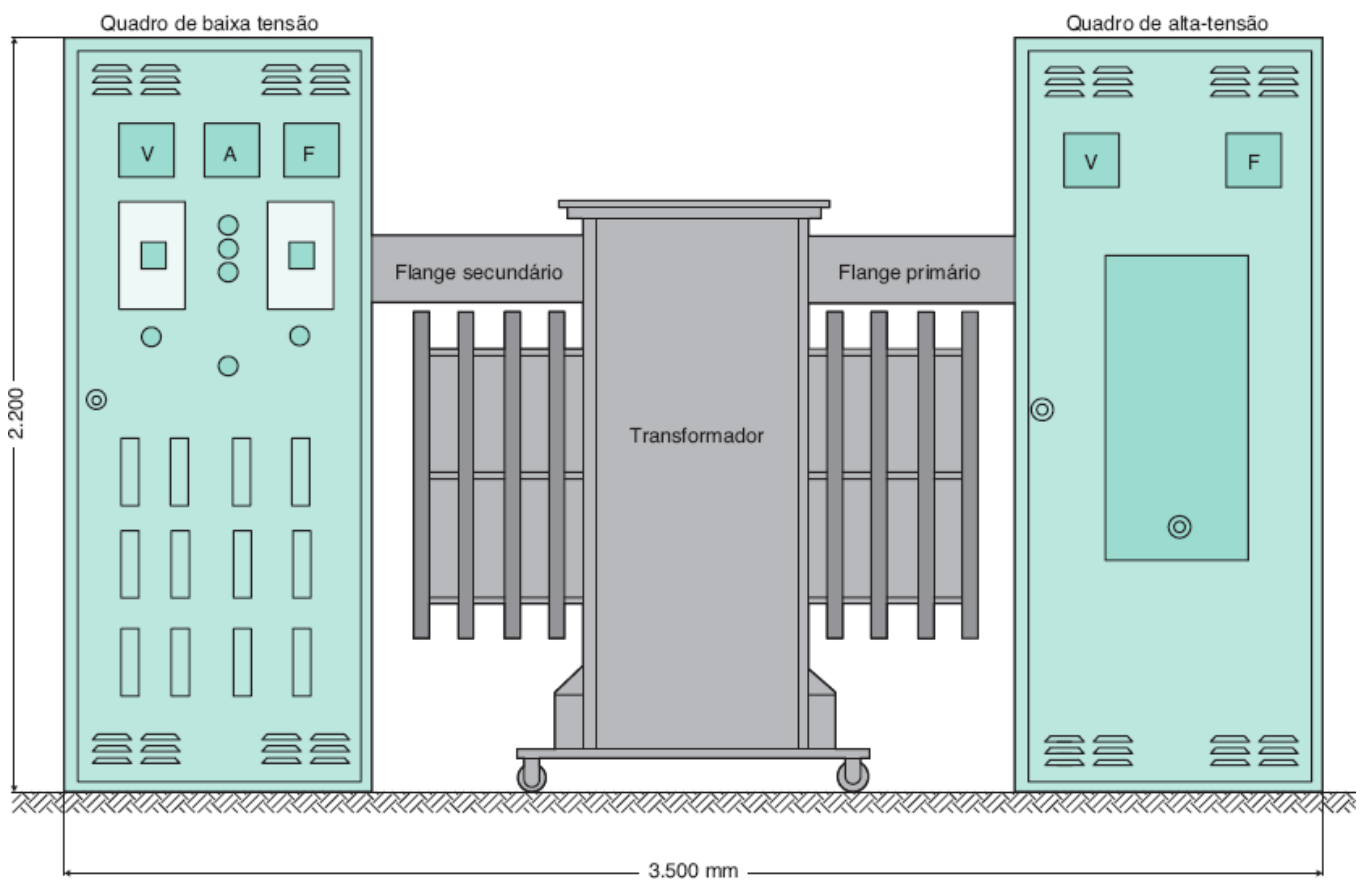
Vista frontal de uma subestação modular metálica, do tipo flange lateral.
